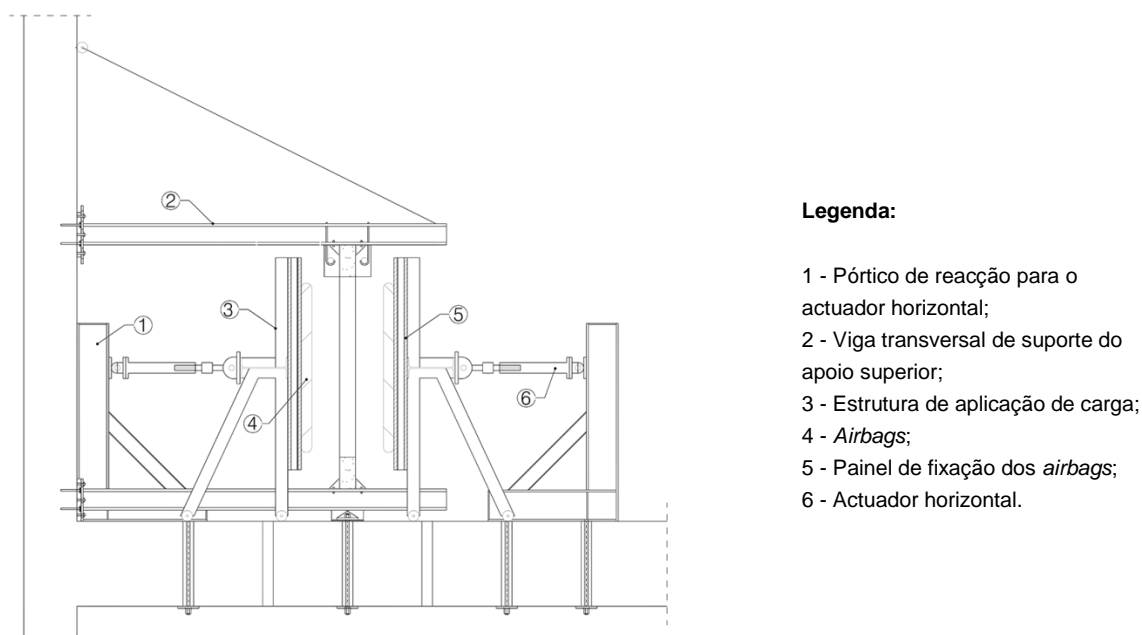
Infraestrutura para o ensaio fora do plano.
